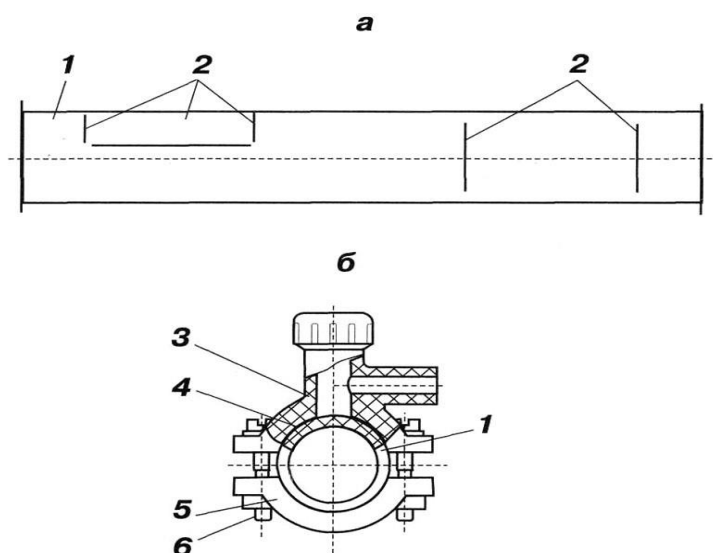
Соединение полиэтиленовой трубы и отводов с закладными нагревателями: а – схема разметки; б – отвод с седловым нагревателем;
